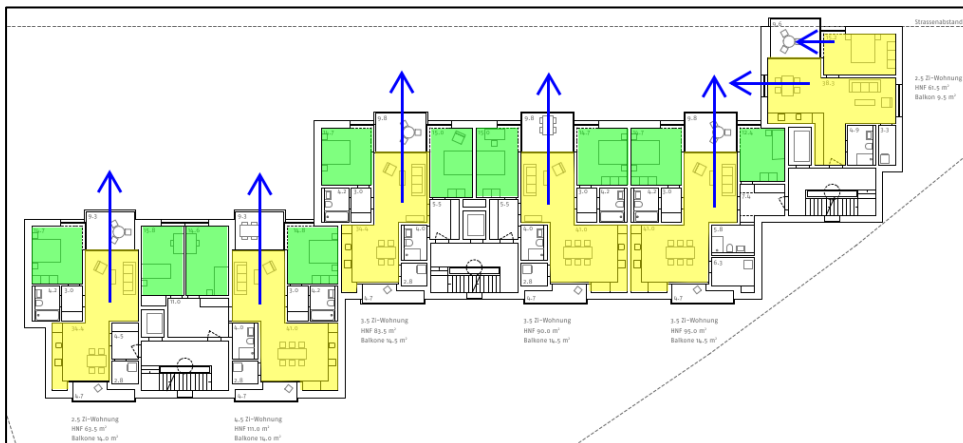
Grundriss Regelgeschoss im aktueller Planstand, eingefärbt gemäss Ampelsystem (4.OG)
